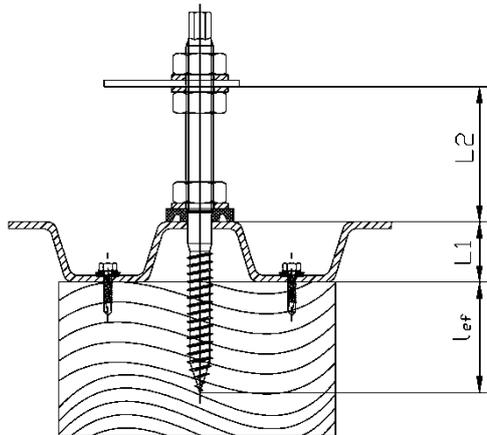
Befestigung der Profiltafeln bei Verwendung der Stockschrauben
